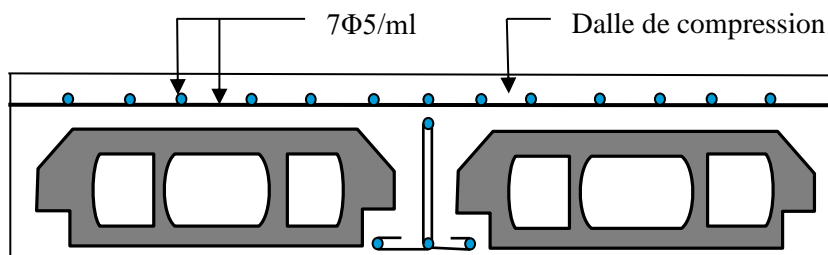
Schéma de ferrailage de la dalle de compression.
